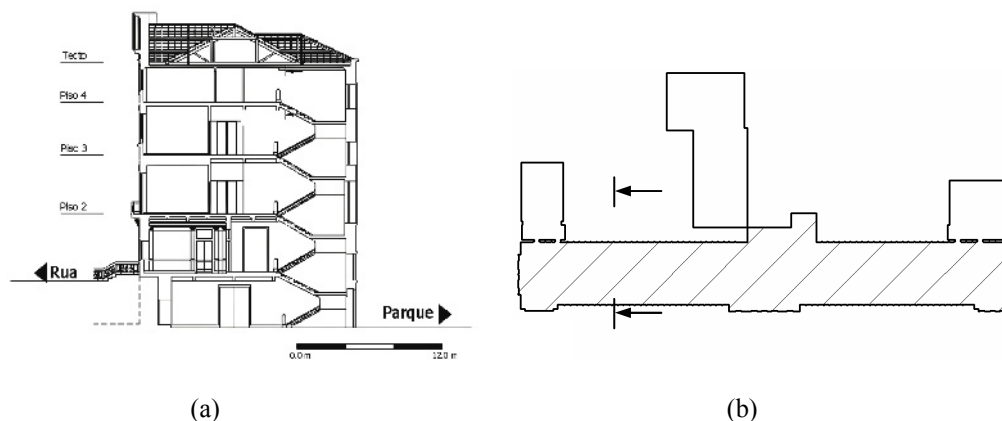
Seminário Conciliar de Braga (escalas distintas): (a) corte transversal indicado em planta; (b) planta com zona a reforçar
